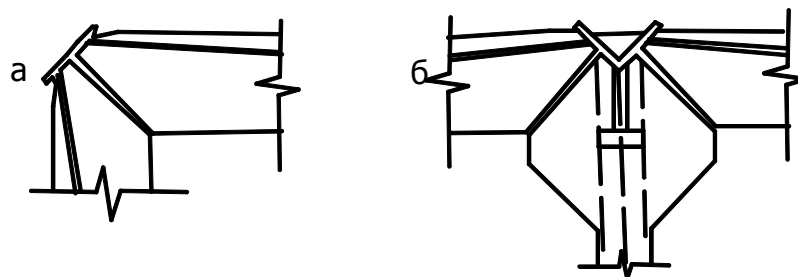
Вузол спрєження попередньонапружених ригелїв зї стїєюкю (Італїя):
